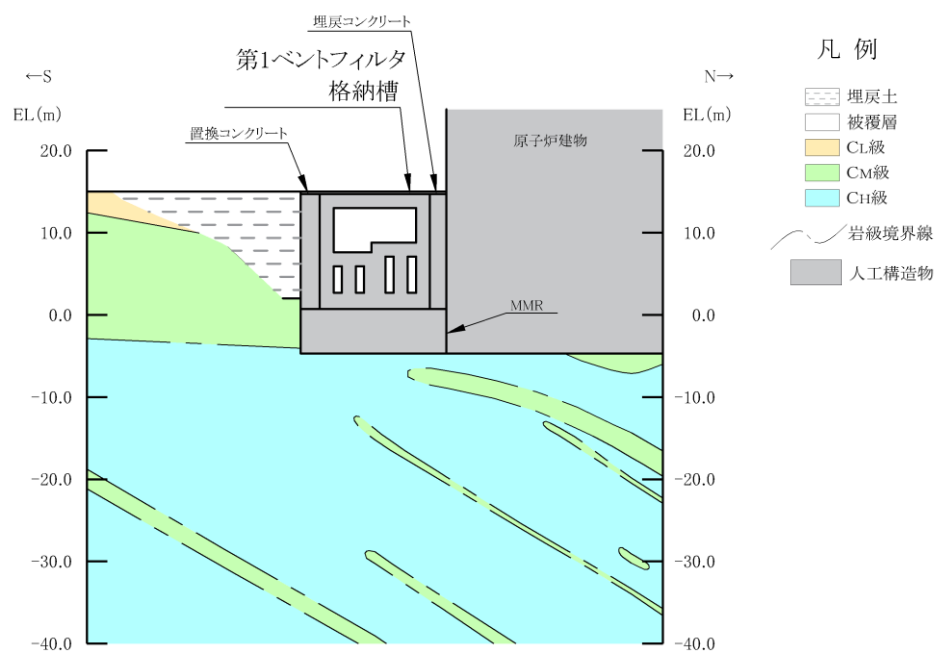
第 1 ベントフィルタ格納槽 評価対象断面図 (B-B 断面)
